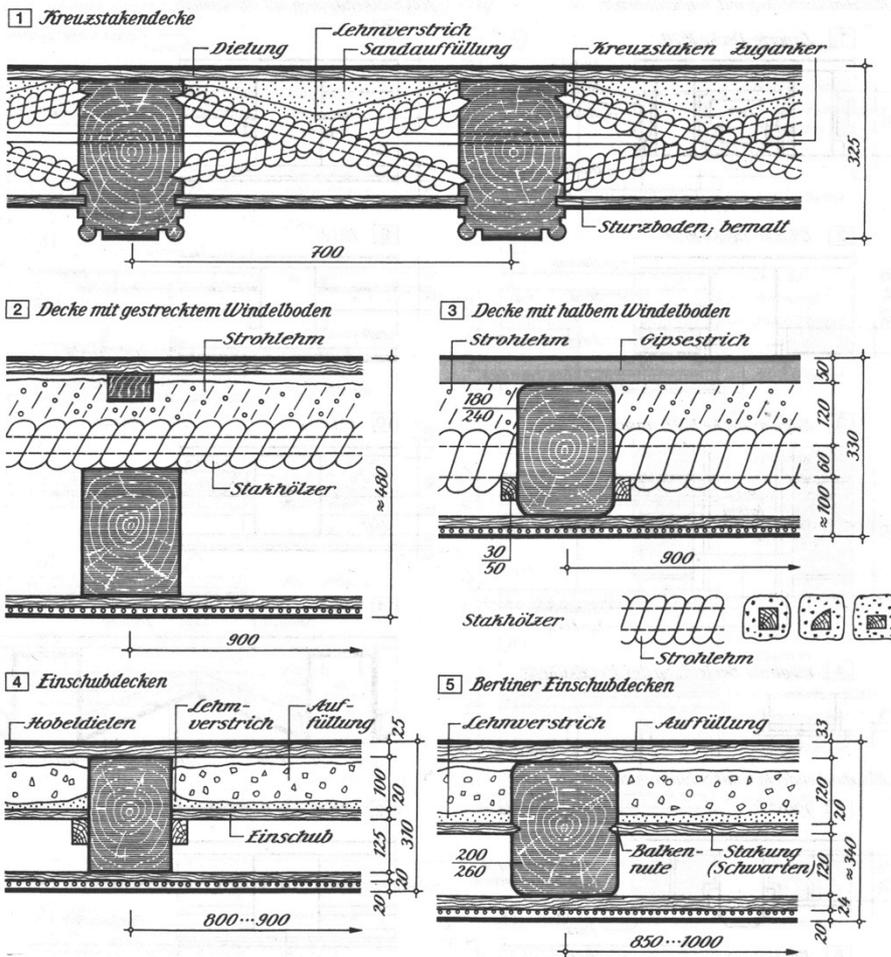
Holzbalkendecken: Ahnert/Krause Bd.2 S. 29
